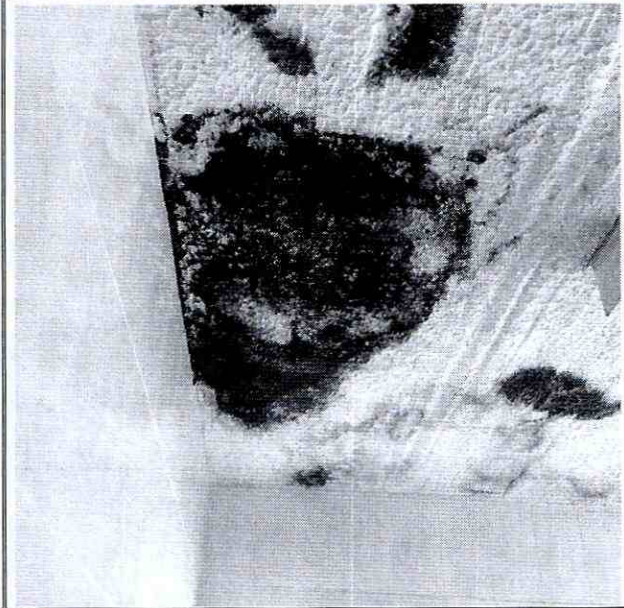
y 5. Desprendimientos capa de recubrimiento estructura de cubierta y presencia de eflorescencias
